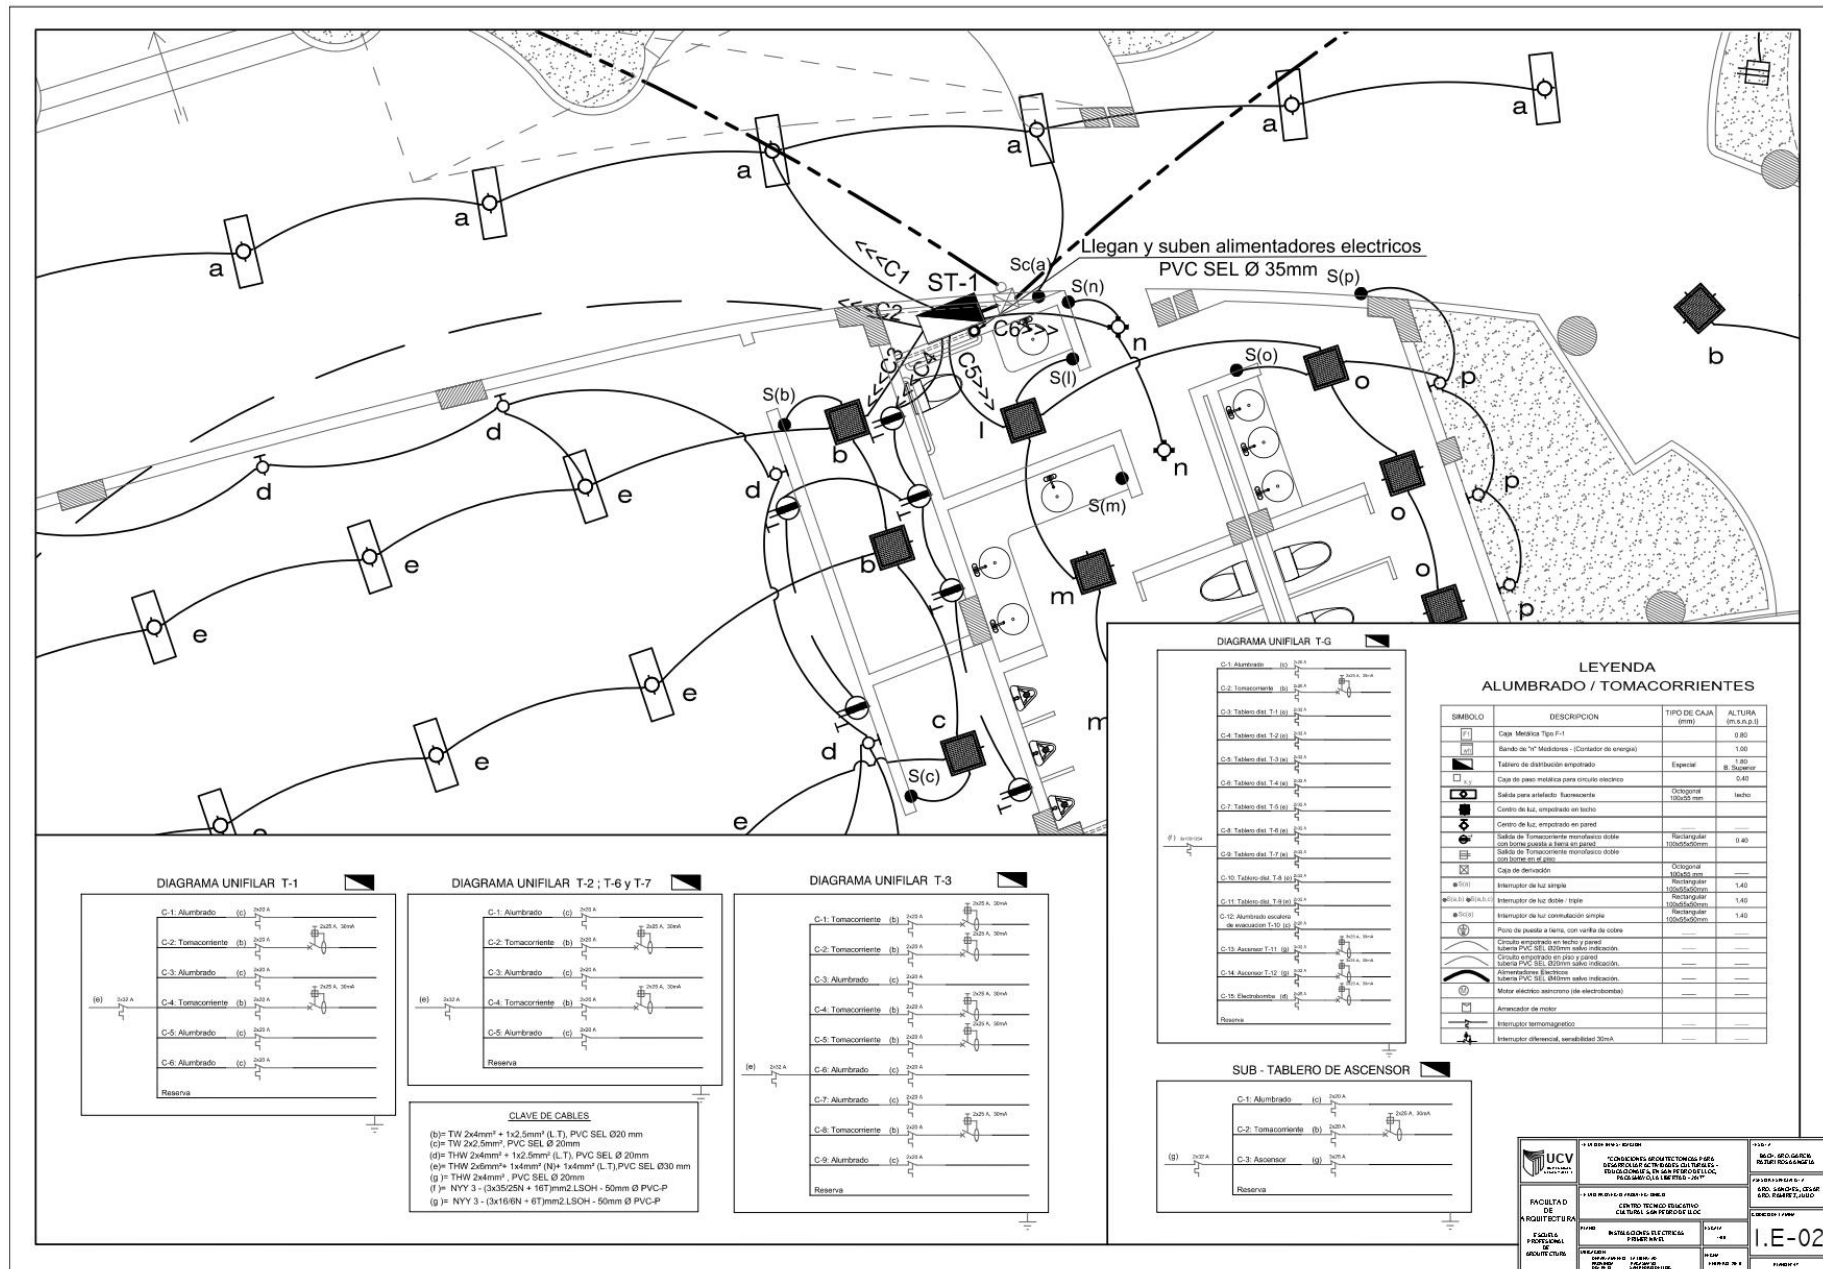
Plano de Instalaciones Eléctricas 1er Nivel - Plano N° 47 - Lámina N°: I.E. - 02
